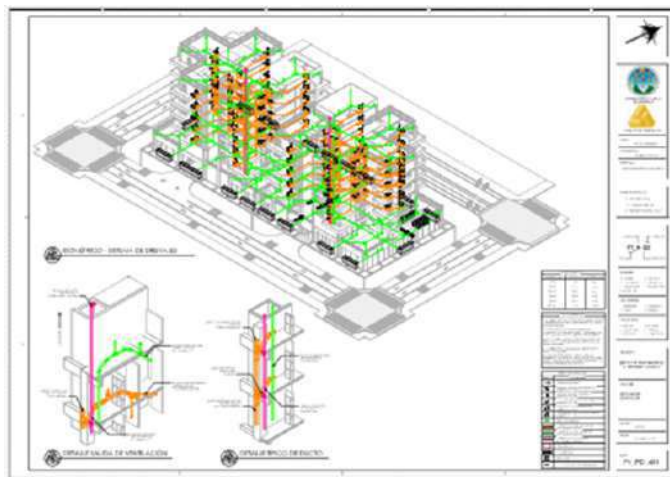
Ejemplo de plano de instalaciones hidrosanitarias trabajado para la entrega de juego de planos de instalaciones del Edificio de Apartamentos solicitado para Diseño Arquitectónico 7. Elaborado por Jonathan Rodriguez. Guatemala, Abril de 2017.
